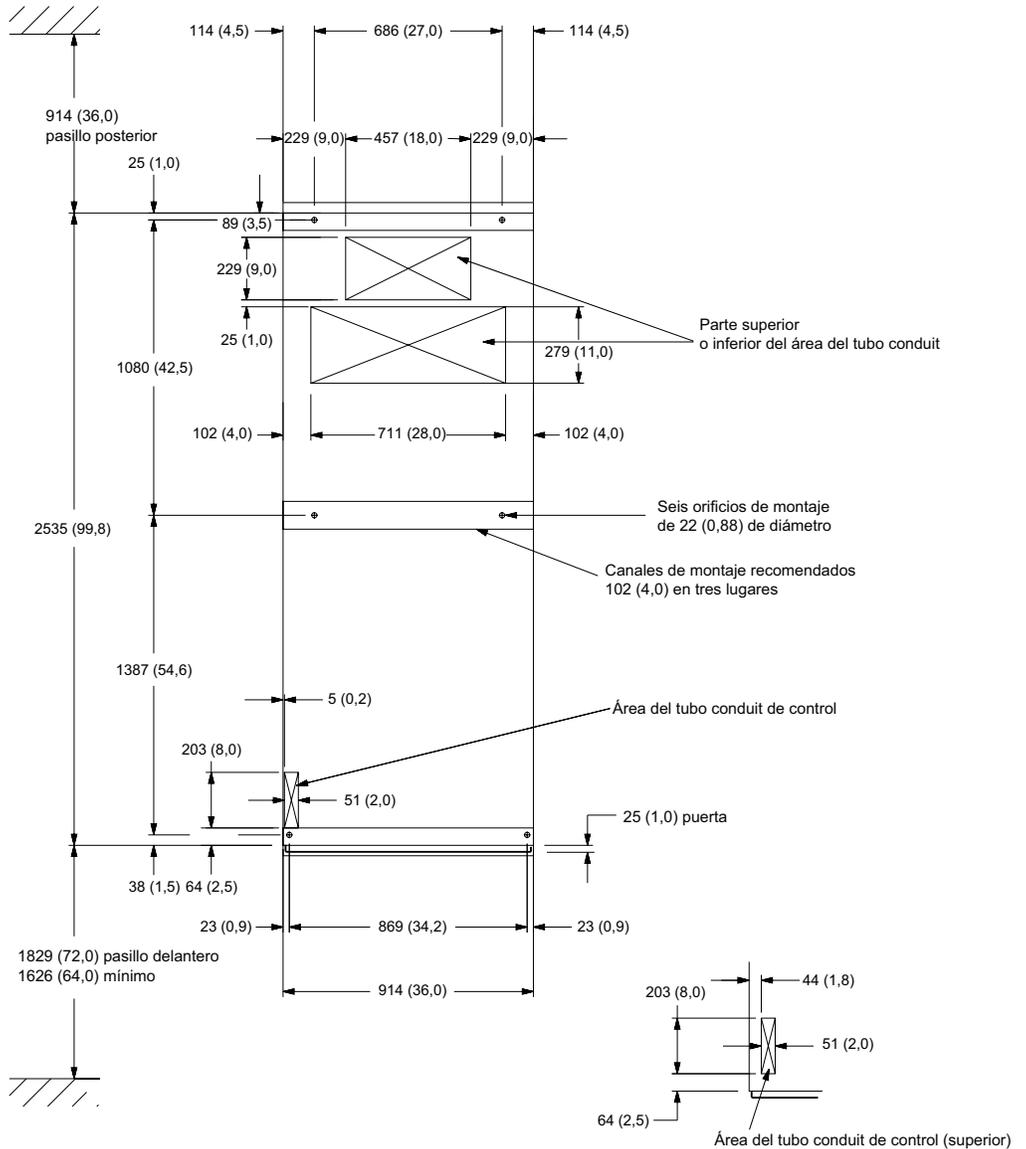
Plano de planta extendido Masterclad para tablero de fuerza de 63 kA
